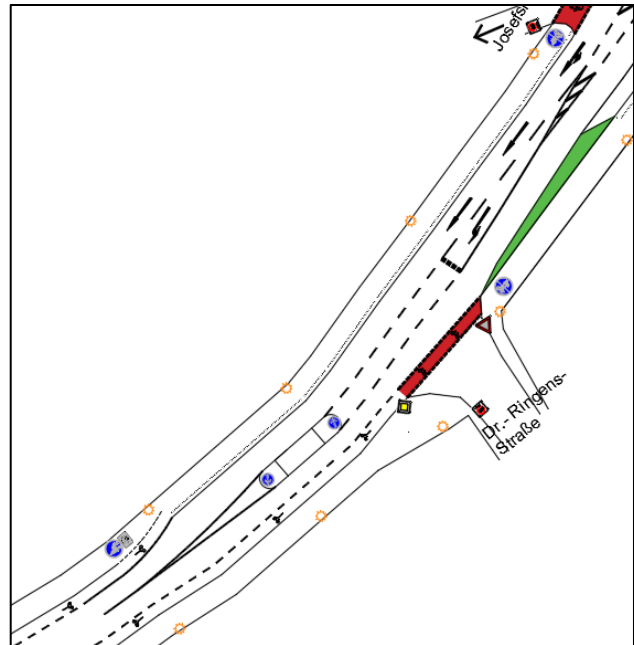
Hauptstraße - Dr.-Ringens-Straße, Plananschnitt P9 (eigene Darstellung)
